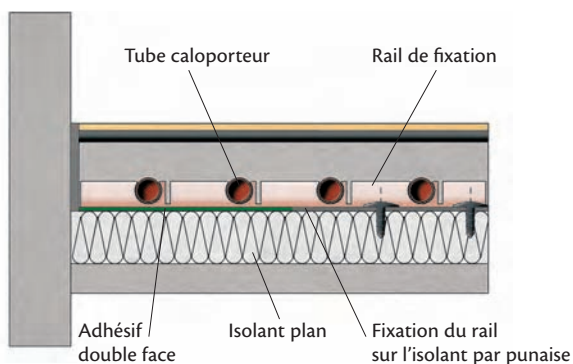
Pose du tube sur isolant plan : fixation à l'aide de rail à encoches
